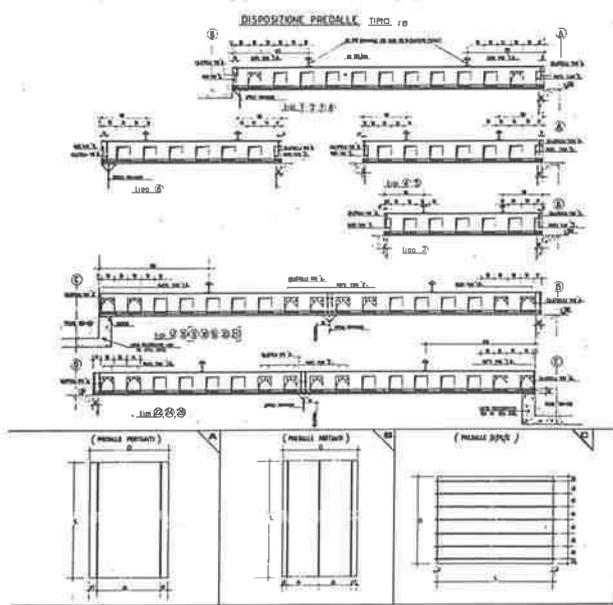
Elementi prefabbricati autoportanti di sostegno del getto del solaio di copertura della Zona Pompe.
